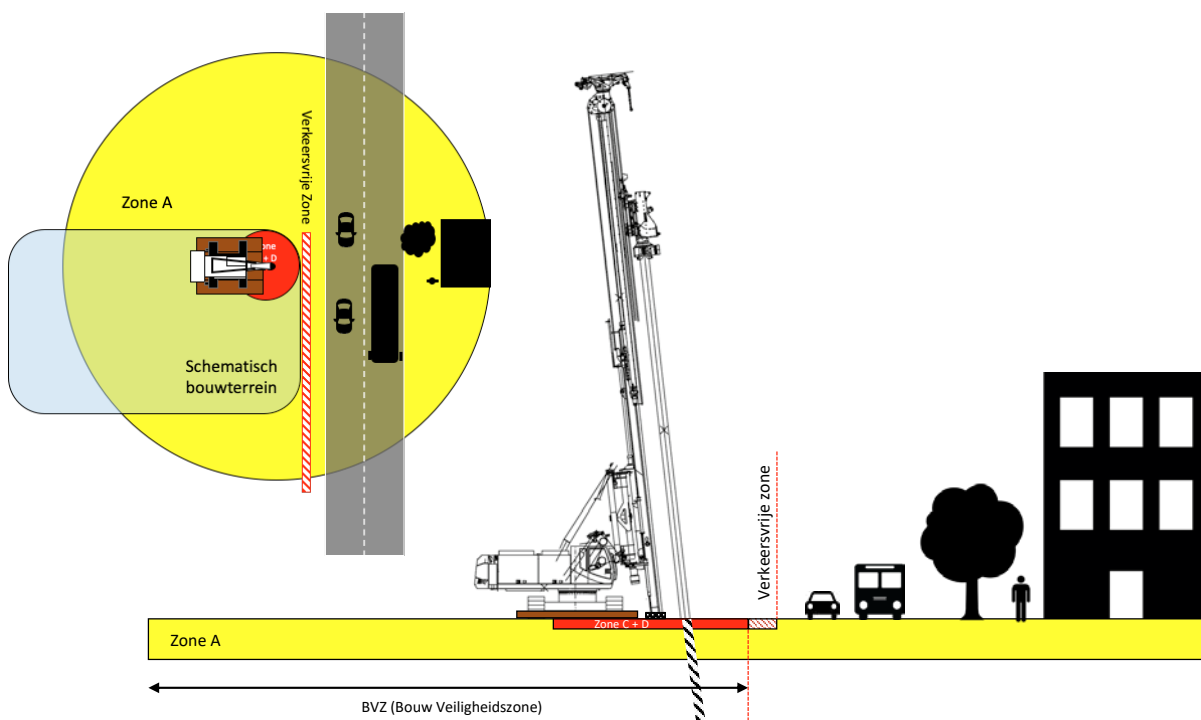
Overzichtstekening te lood funderen met PD-stelling/giekstelling & GLS-stelling/vouwstelling/sheetpilar – type vouwstelling (hoofdgroep B en C)
